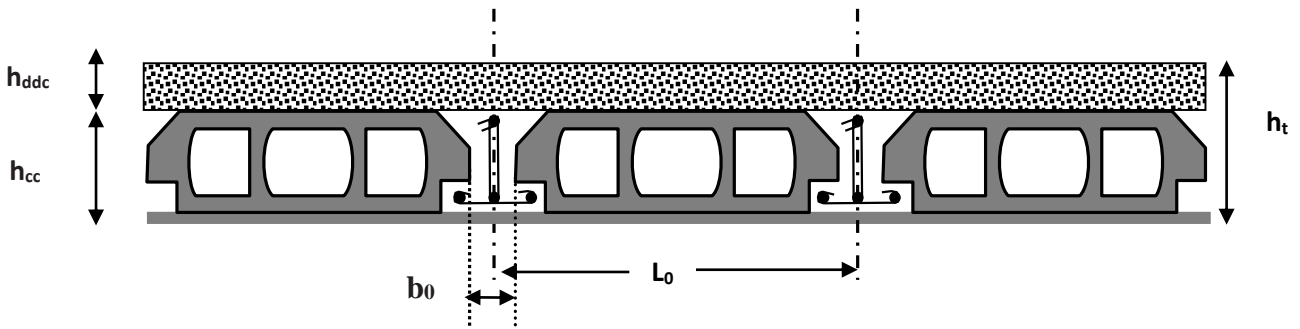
Coupe transversale sur un plancher à corps creux.
